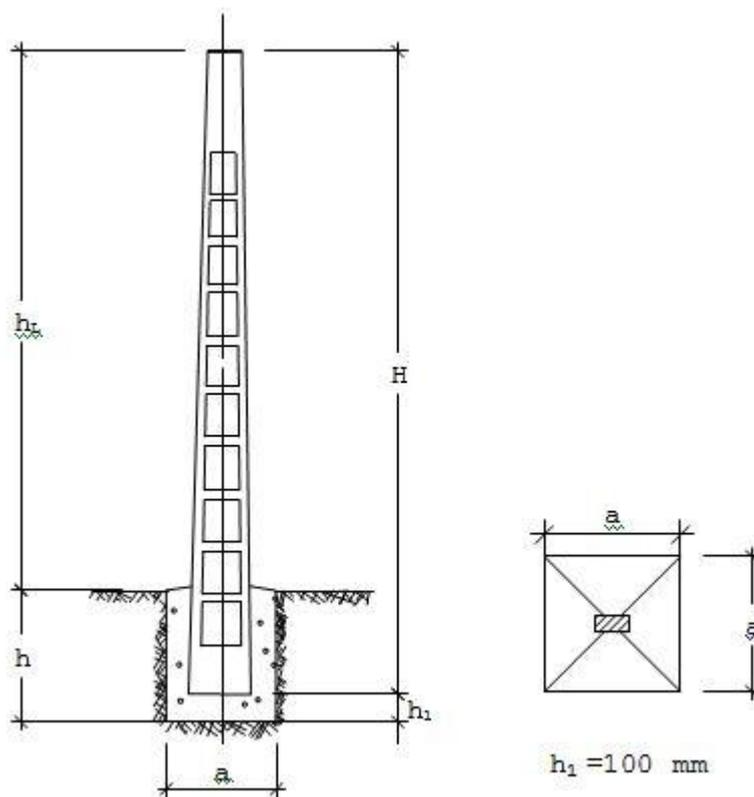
Características apoyos de hormigón vibrado.
